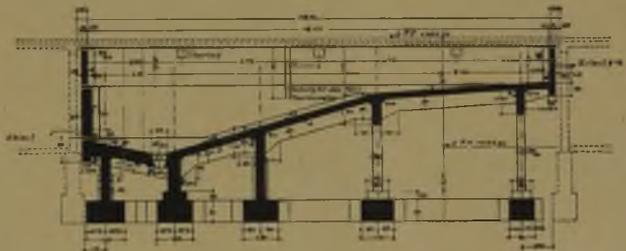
Badhaus S. (Vergl. Lageplan Abb. 1.) Längsschnitt A-B durch das Schwimmbecken.
